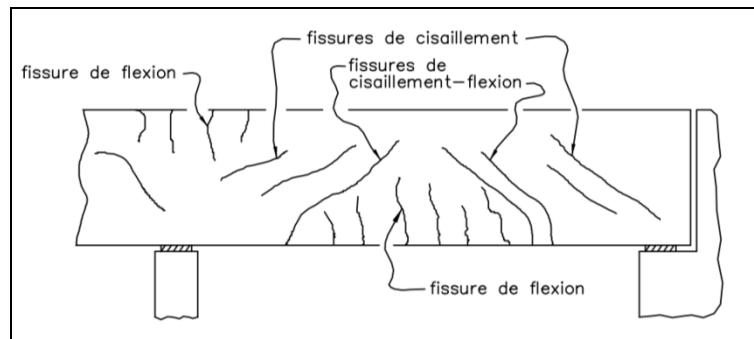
Types de fissures dans une poutre de béton armé
